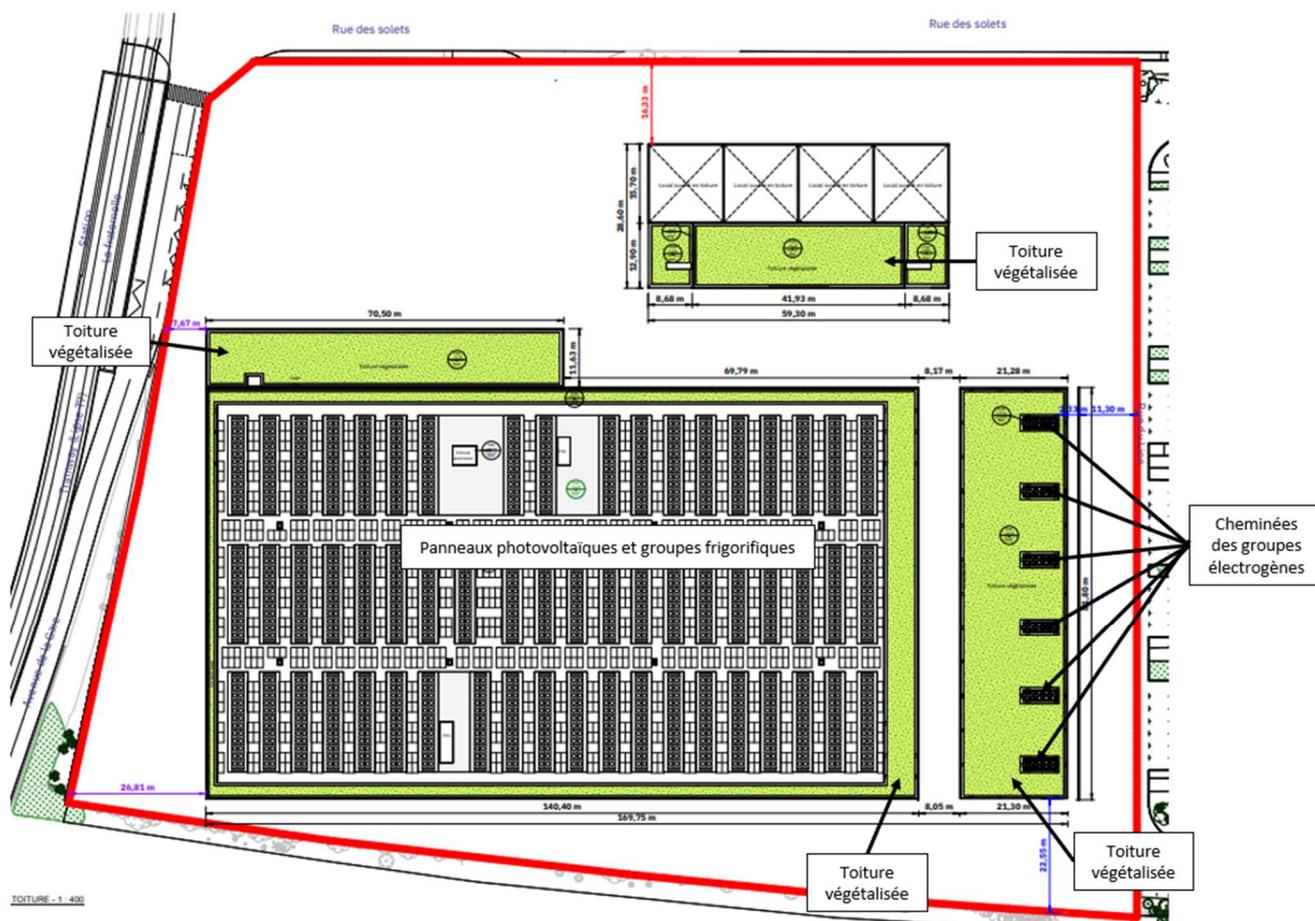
Plan des toitures des bâtiments (source : ENIA)
